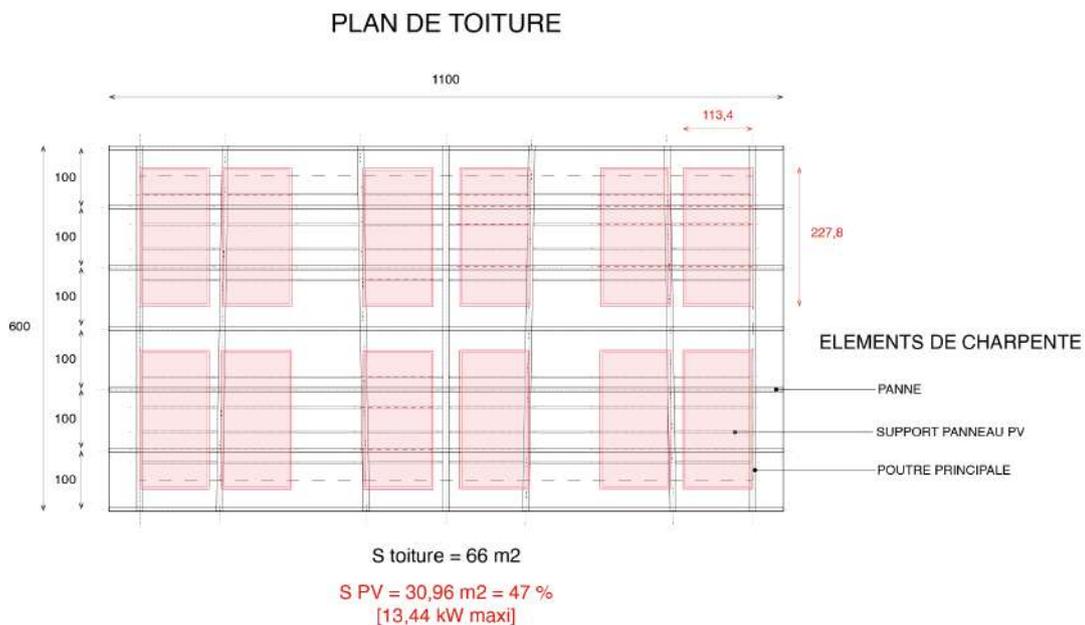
plan d'étude d'implantation de panneaux photovoltaïque en toiture (crédit personnel)
